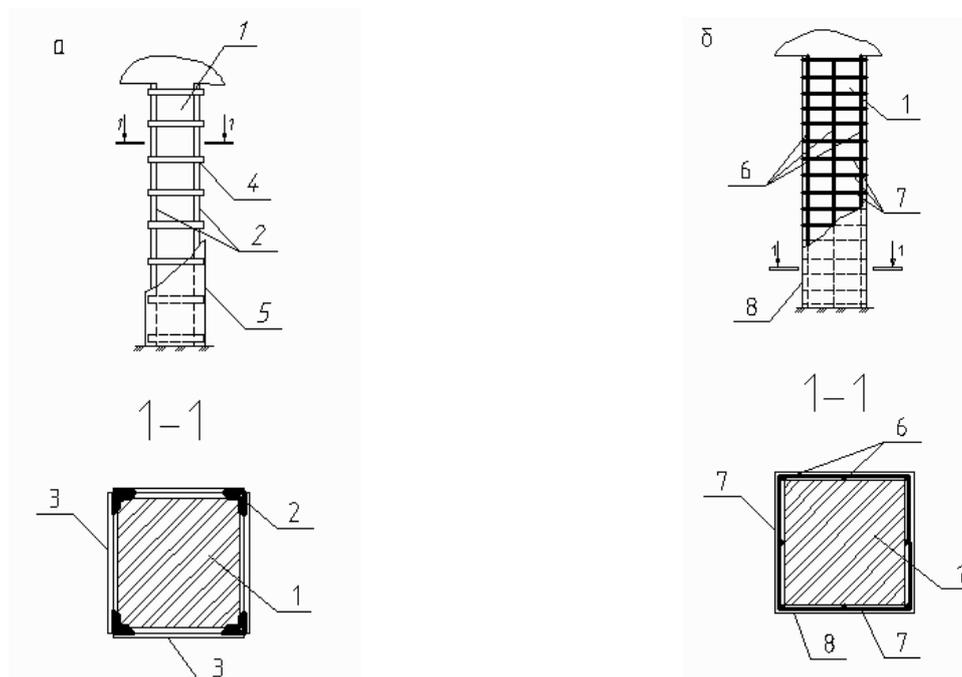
Схема усиления поврежденных простенков и столбов обоями: *а* – стальной, *б* – железобетонной или армированной раствором; 1 – усиливаемый столб или простенок; 2 – уголки обоймы; 3 – поперечные планки; 4 – сварка; 5 – штукатурка цементно-песчаным раствором; 6 – стержни диаметром 6 – 12 мм; 7 – хомуты диаметром 4 – 10 мм; 8 – раствор марки 75 – 100 или бетон класса В12.5 – В15
